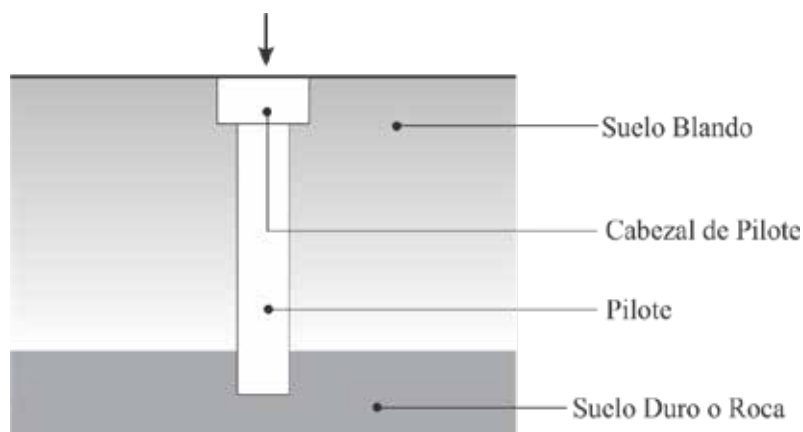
Detalle de sistema de pilotajes en suelos inestables. (2016)
